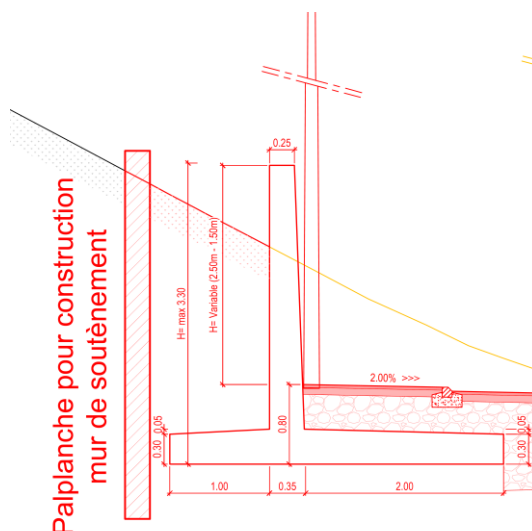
Extrait de la pièce f. – Coupe sur l'ouvrage (source : Groupement VERO).
